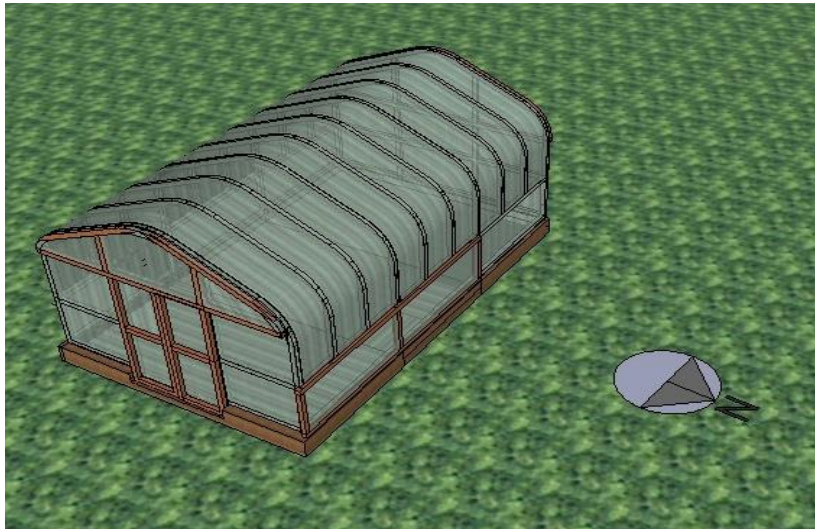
Vista exterior con cubierta y ventilas cerradas
